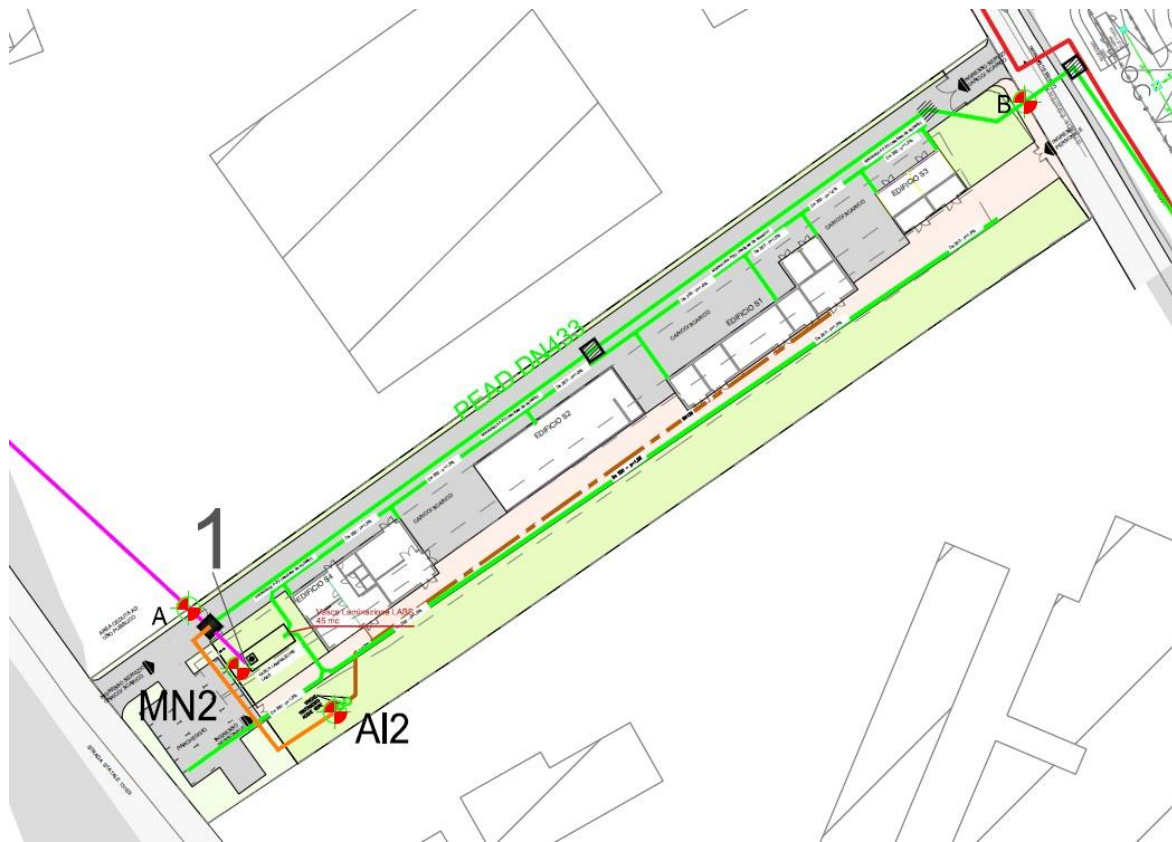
Planimetria reti fognarie – dettaglio area di laboratorio
